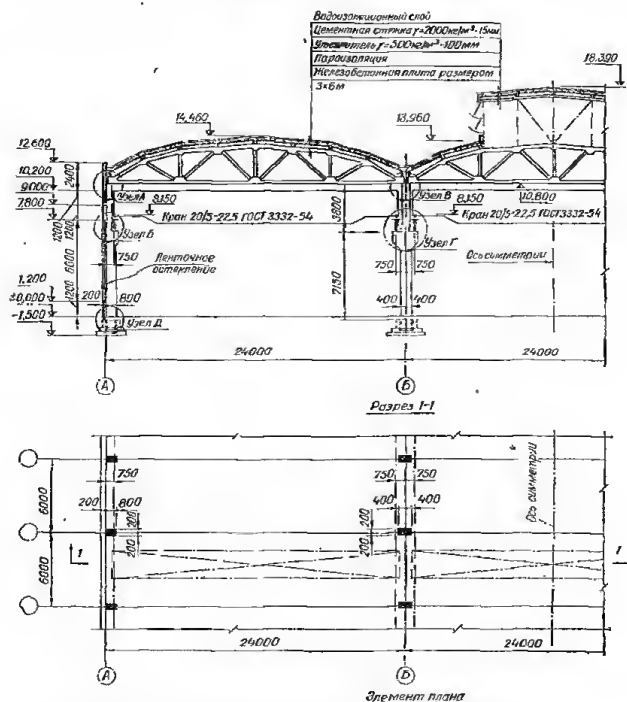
Промышленное здание (поперечный разрез и элемент плана).
